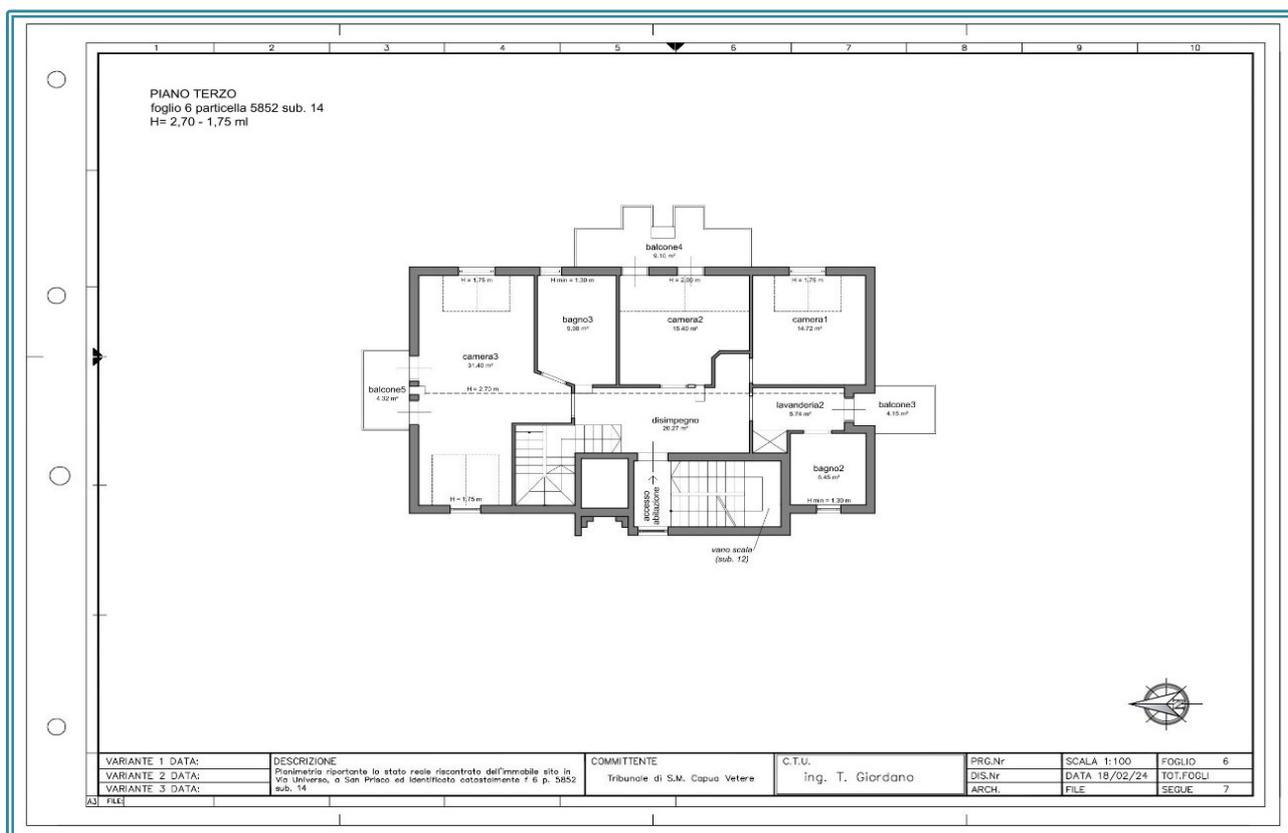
Piano Terzo (sottotetto) LOTTO 4 stato attuale
